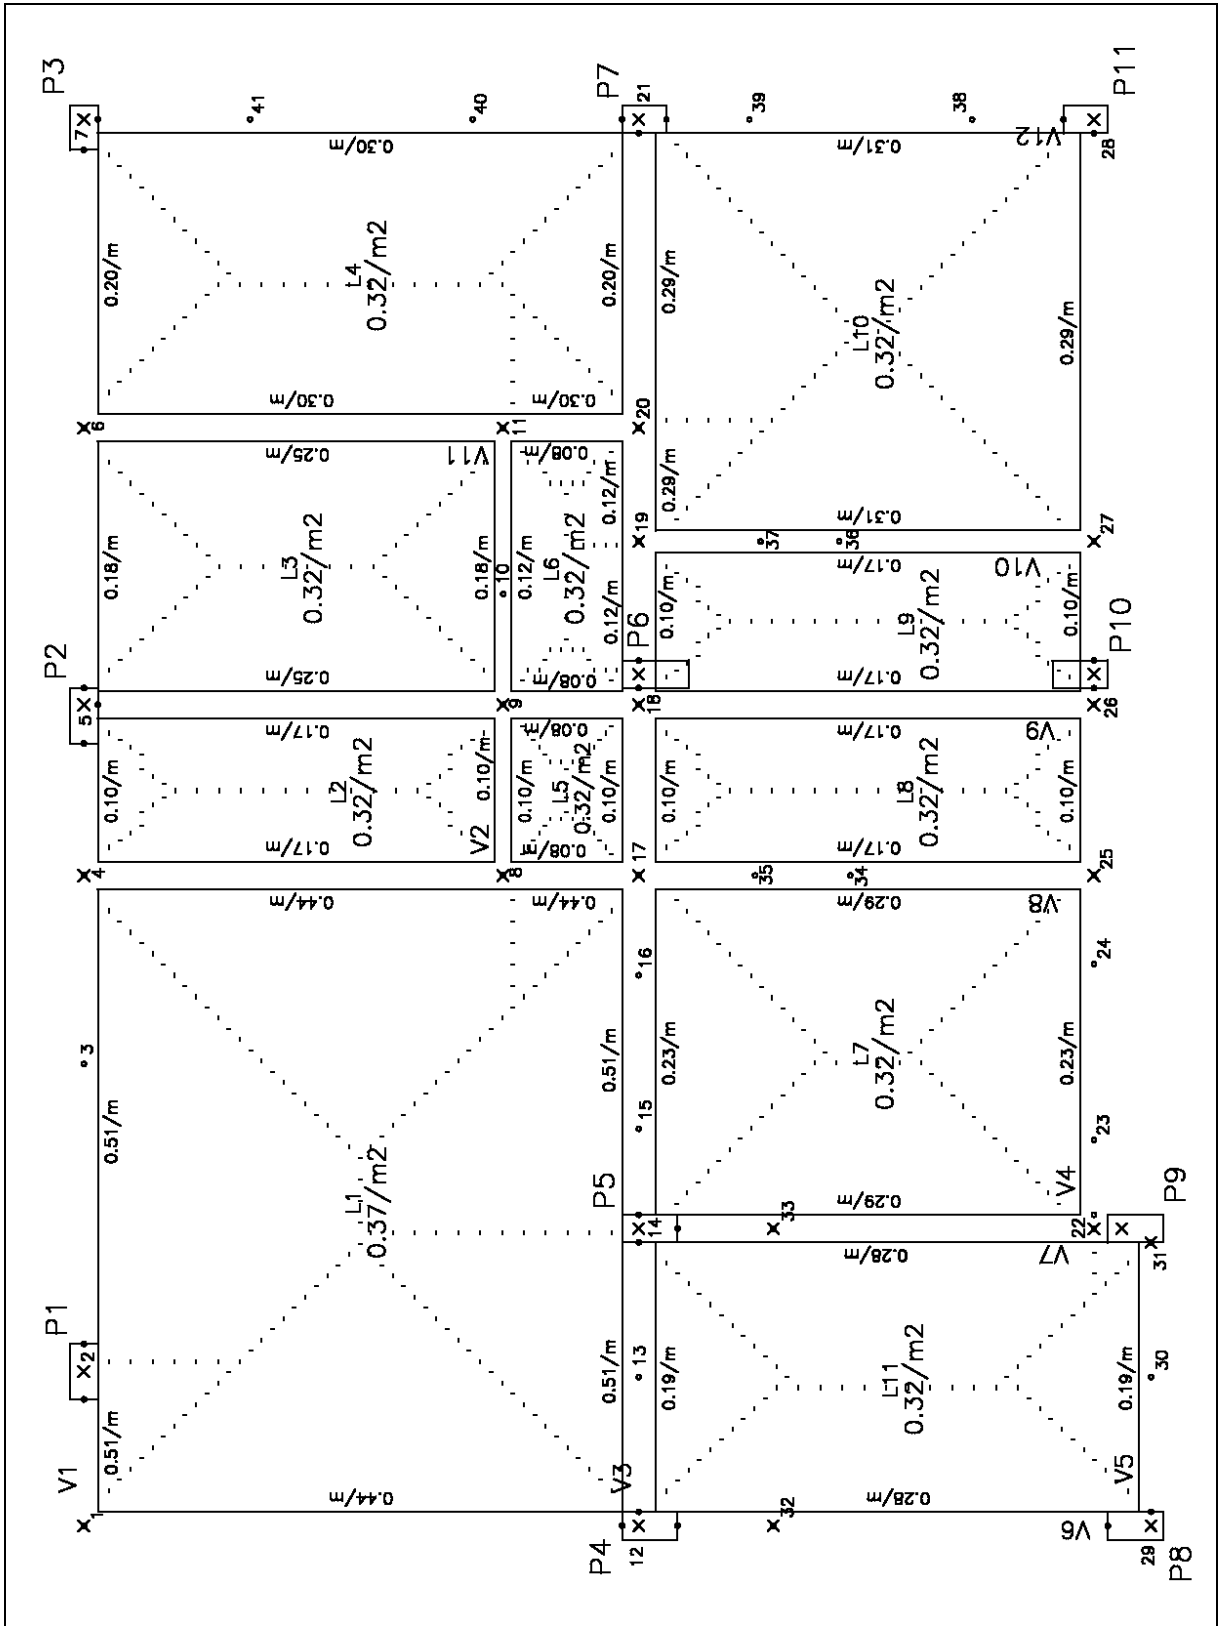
cargas distribuídas sobre as vigas devido às lajes da cobertura
